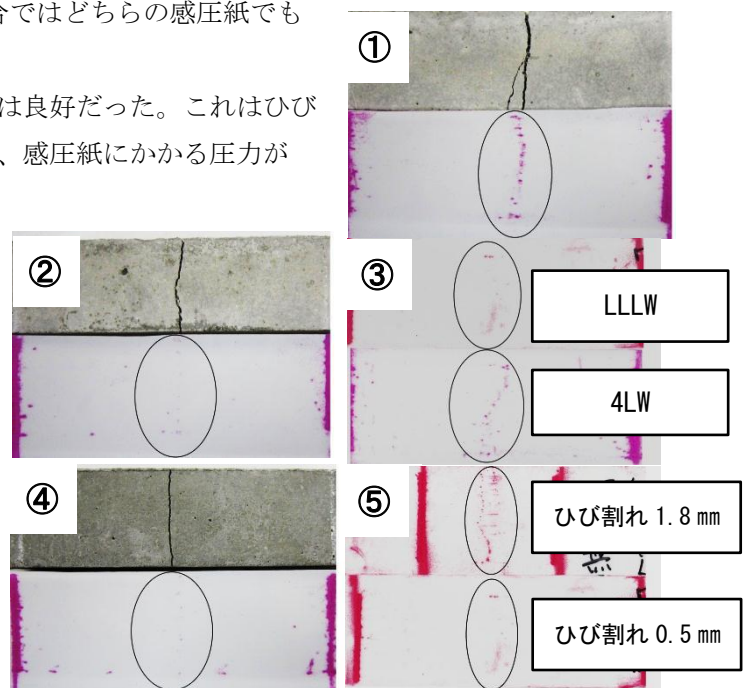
ひび割れの入った供試体と感圧紙
